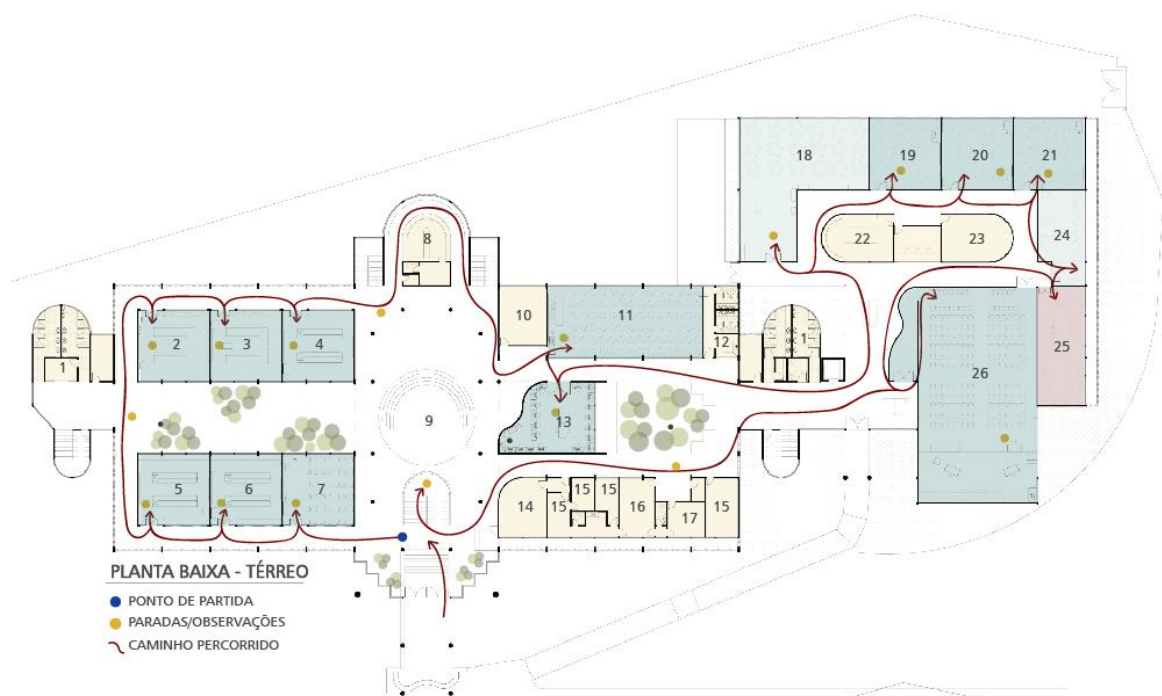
Walkthrough (caminho percorrido): primeiro pavimento -
